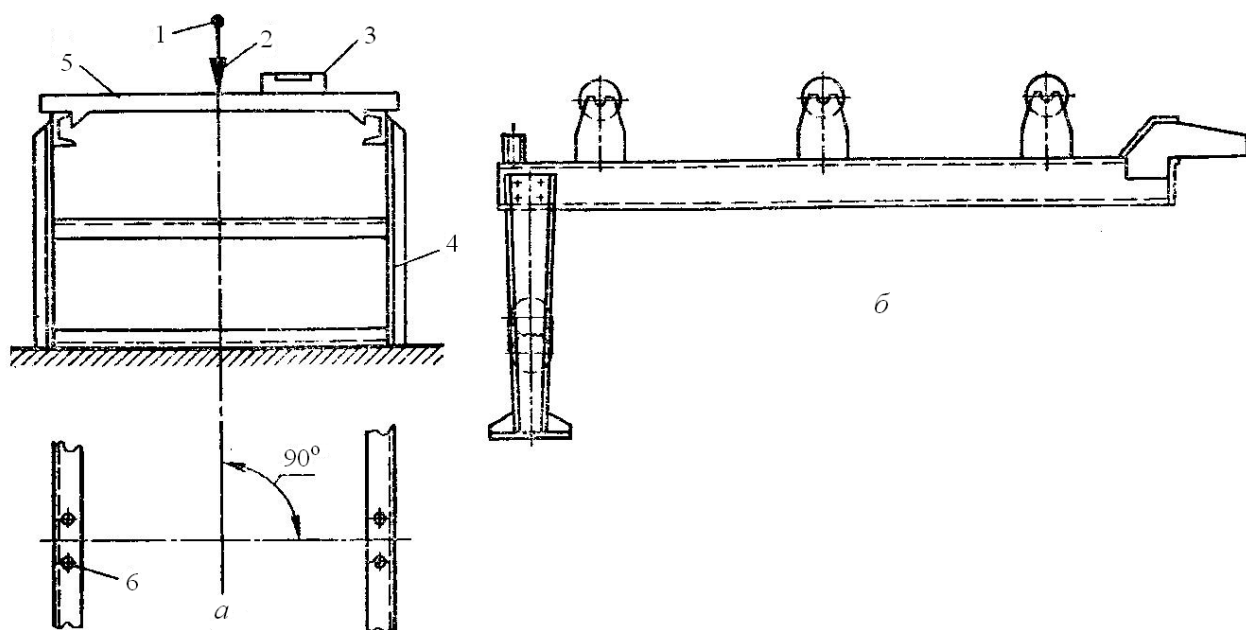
Схема подготовки металлоконструкции к монтажу:
